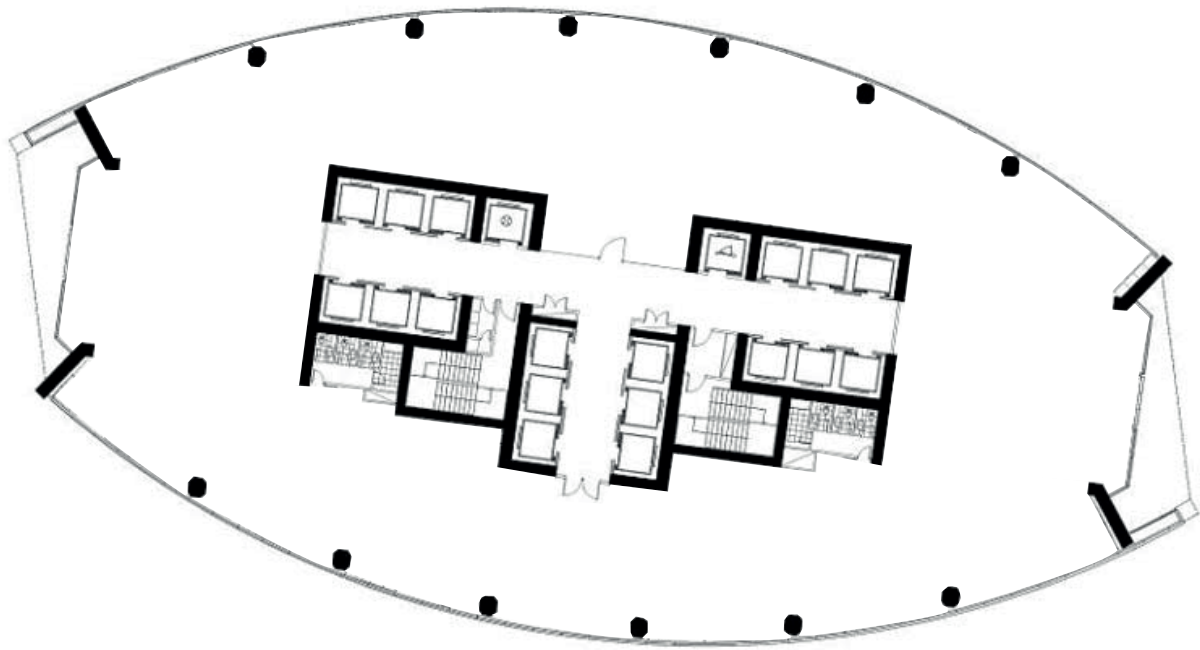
Planta tipo de piso 15 al 53. Fuente de: Elaboración propia.
